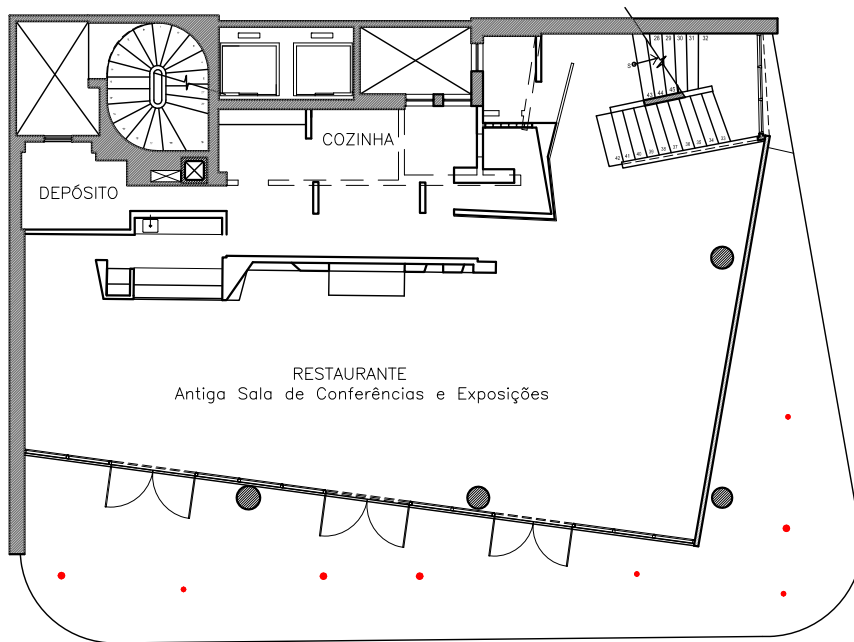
Marquise inferior - Planta de localização dos ralos de captação de águas - 1:200
